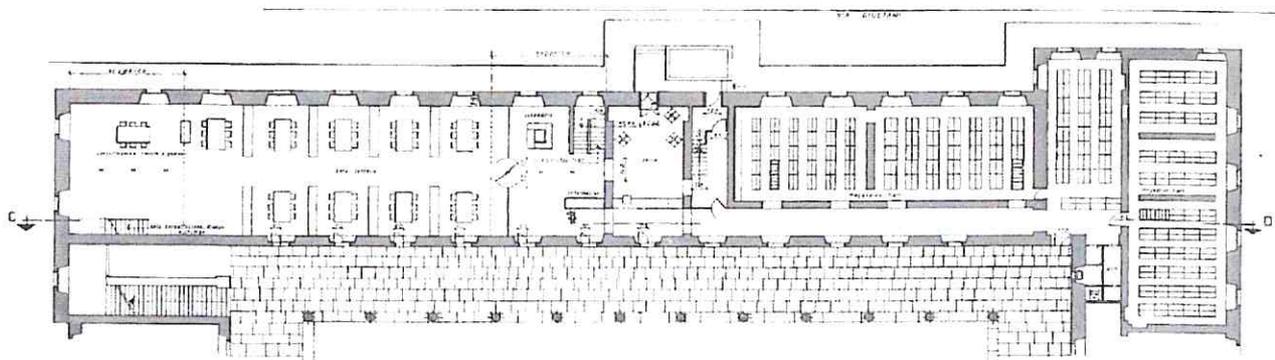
\_Planimetria del progetto dell'intervento dell'arch. Ricci (1965) sui locali dell'ala Nord del Palazzo degli Studi (Biblioteca Civica)
